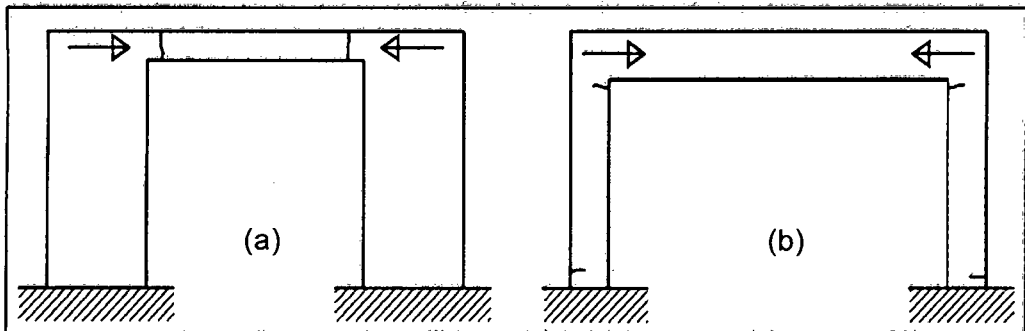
Fisuras características debidas a la retracción Hidráulica del concreto (Broto 2004)
